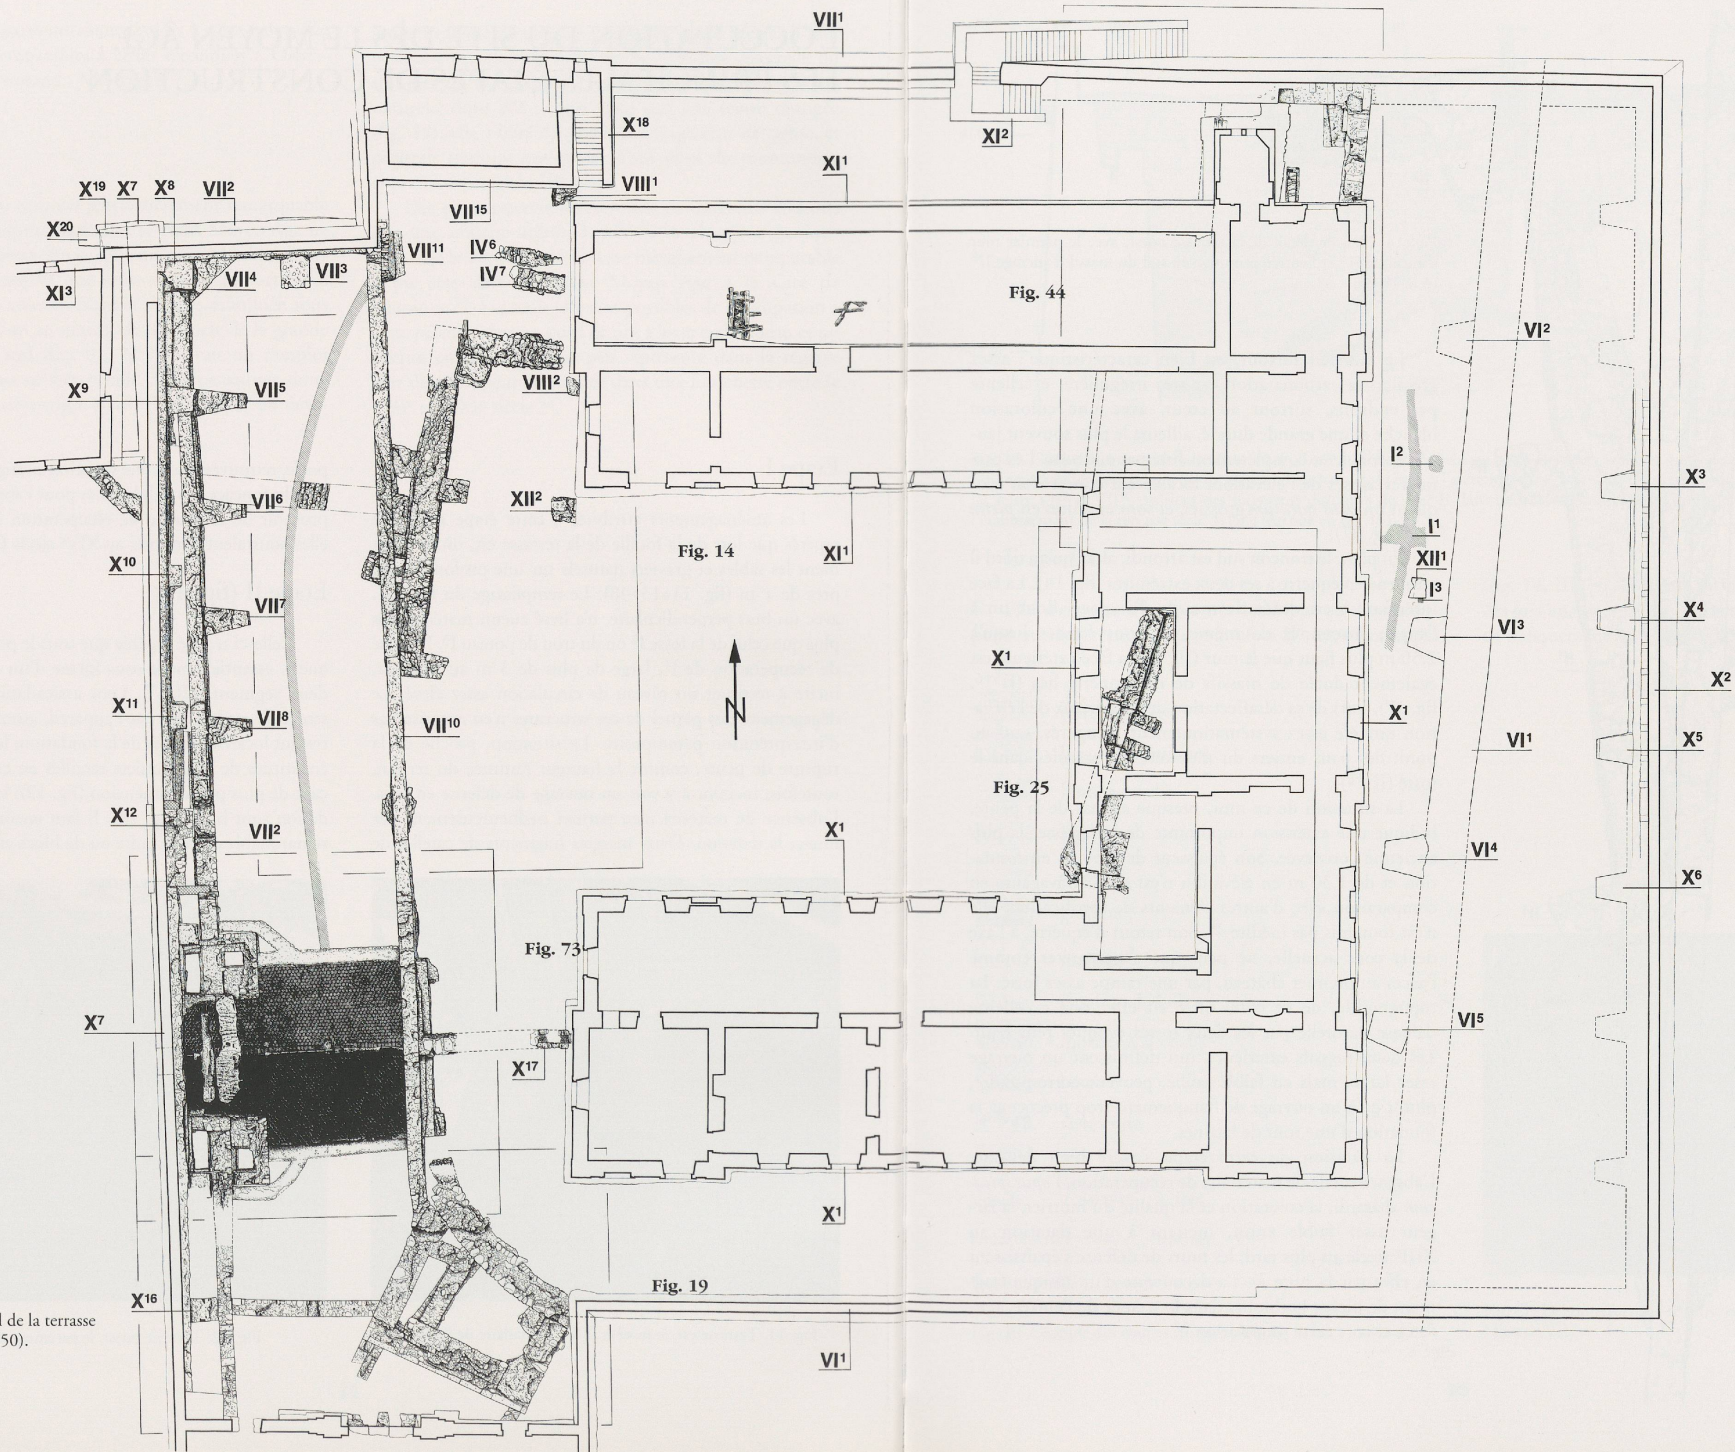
Plan général de la terrasse du château (éch. 1:250).
